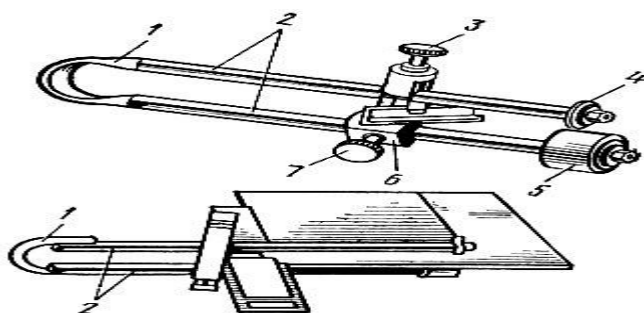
Плиткорез: 1 - стальная пружина, 2 - стальные стержни, 3, 7 - регулировочный и фиксирующий винты, 4 - победитовый резец, 5 - резиновый валик, 6 - движок
